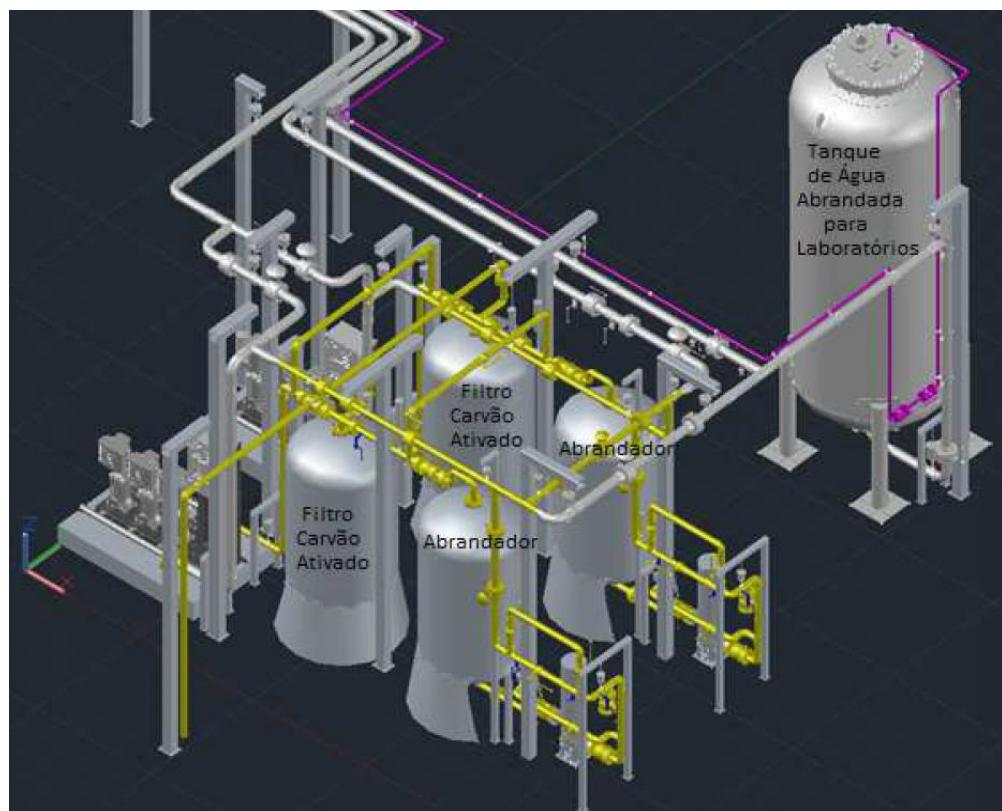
Layout orientativo 3D da planta de fabricação de água abrandada para o circuito C6 que será instalada dentro da casa de bombas 1.
